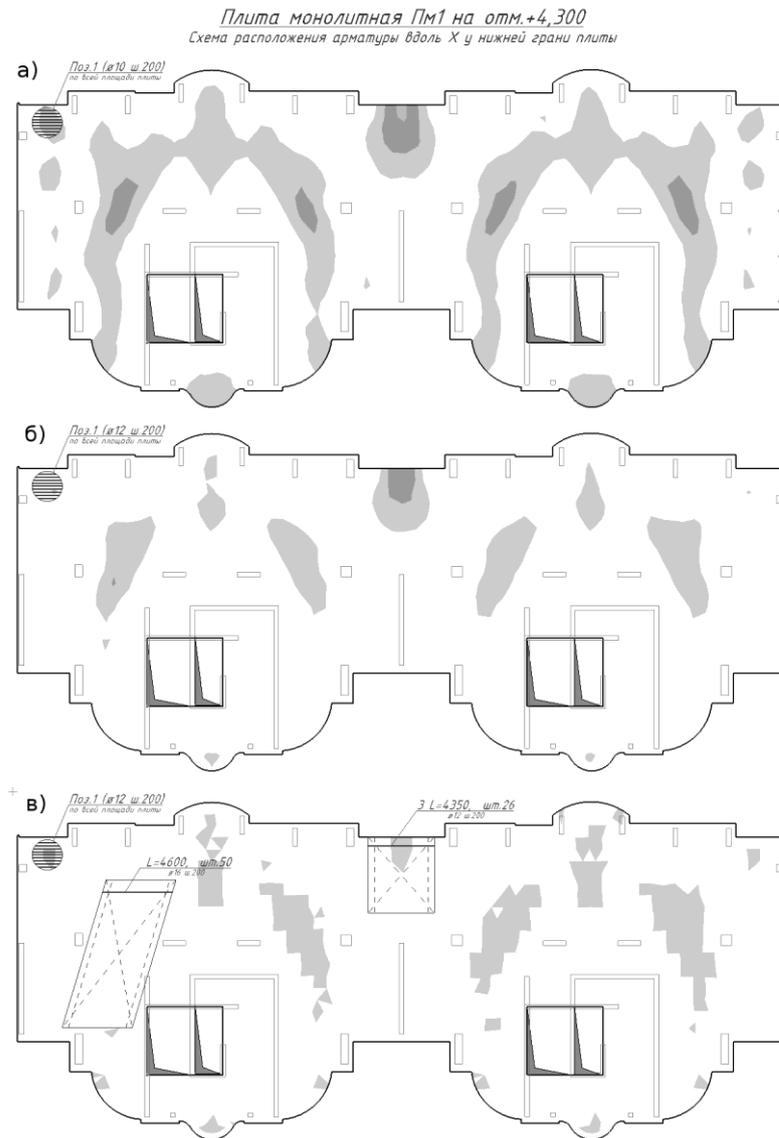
Графическое отображение результатов армирования плиты перекрытия; а) изополя площади армирования с учетом фонового армирования; б) изменение изополей при основном армировании; в) размещение дополнительной арматуры.
